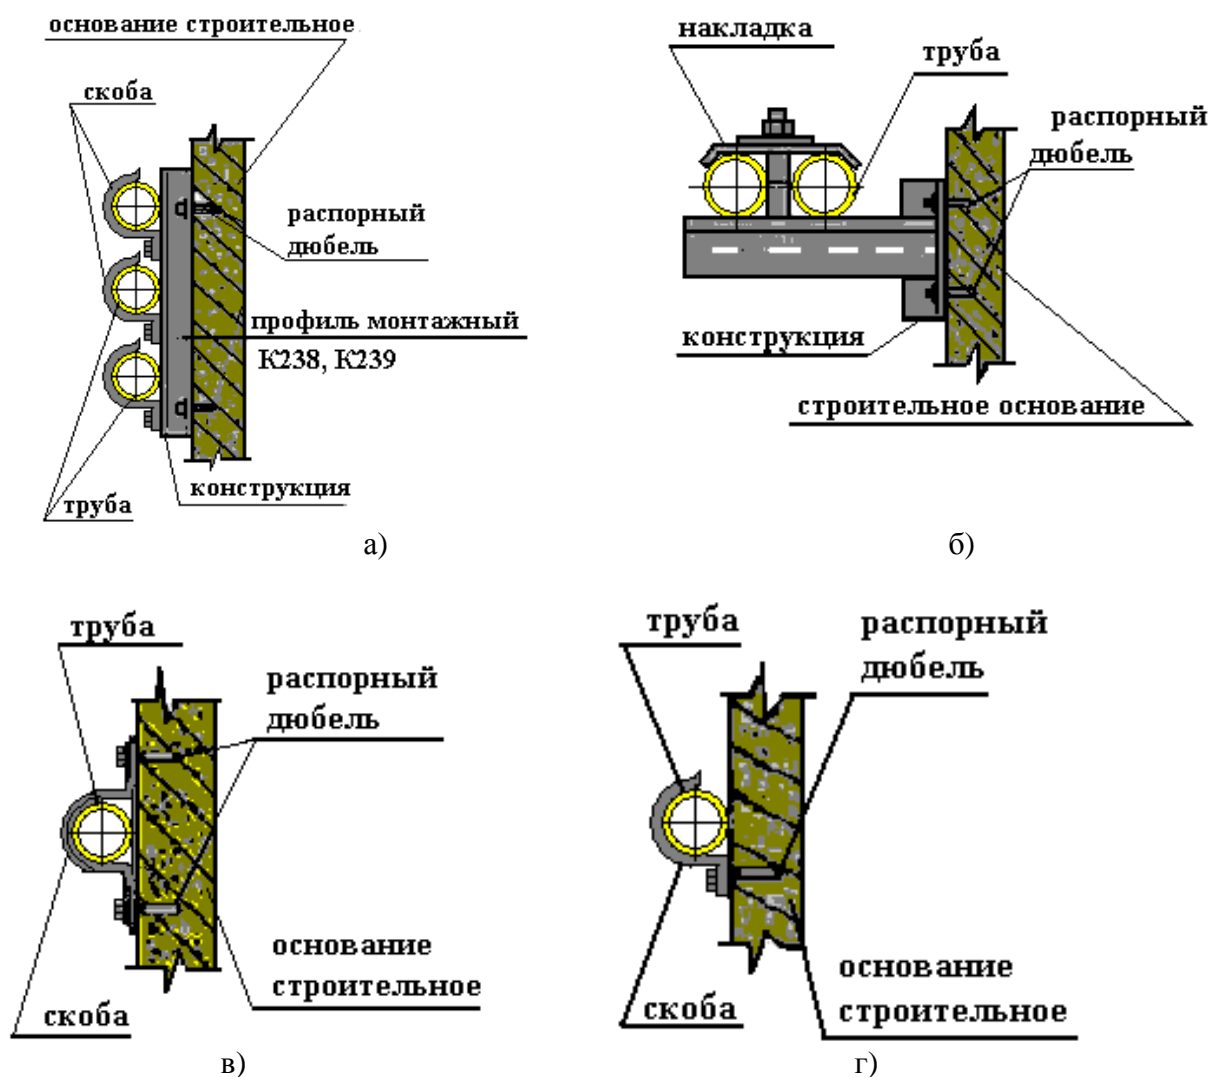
Крепление стальных труб: а) с применением скоб и креплений поддерживающей конструкции к строительному основанию с помощью распорных дюбелей; б) к электромонтажной конструкции с применением накладок к строительному основанию с помощью распорных дюбелей; в) к строительному основанию скобами «К» с помощью распорных дюбелей; г) к строительному основанию скобами K252-254 с помощью распорных дюбелей
